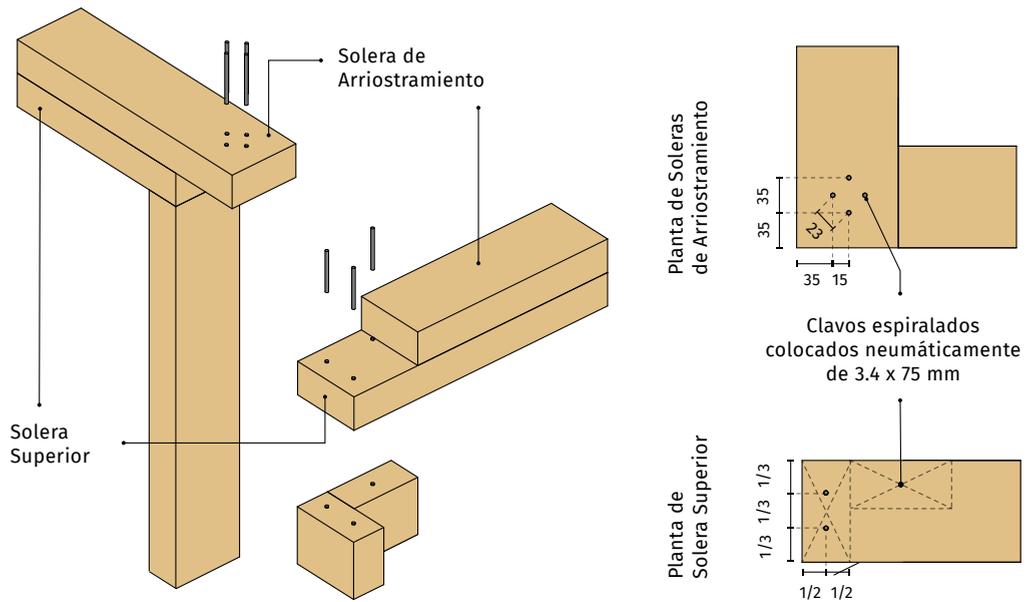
C. Clavadura de solera a montantes y entre soleras en esquina
